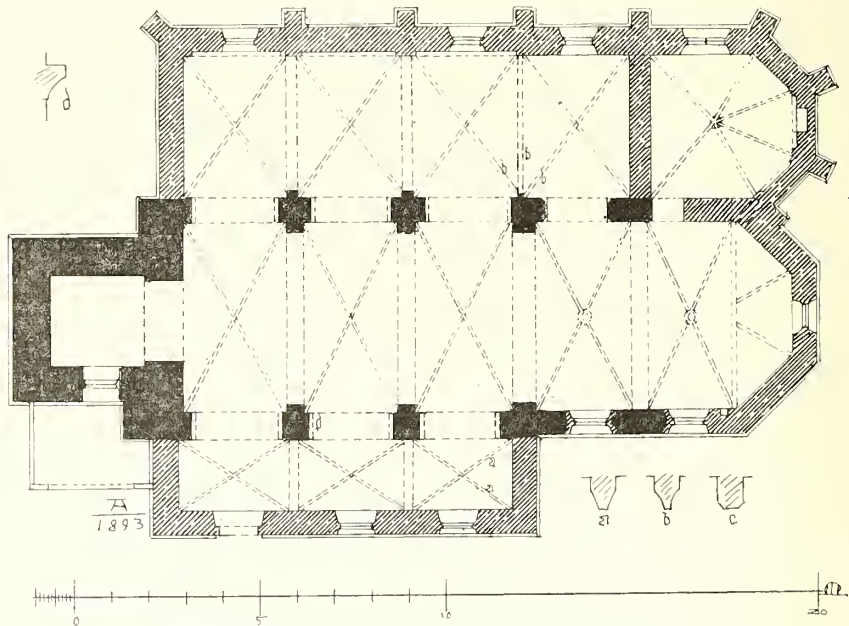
Thorr. Grundriss der alten katholischen Pfarrkirche.
